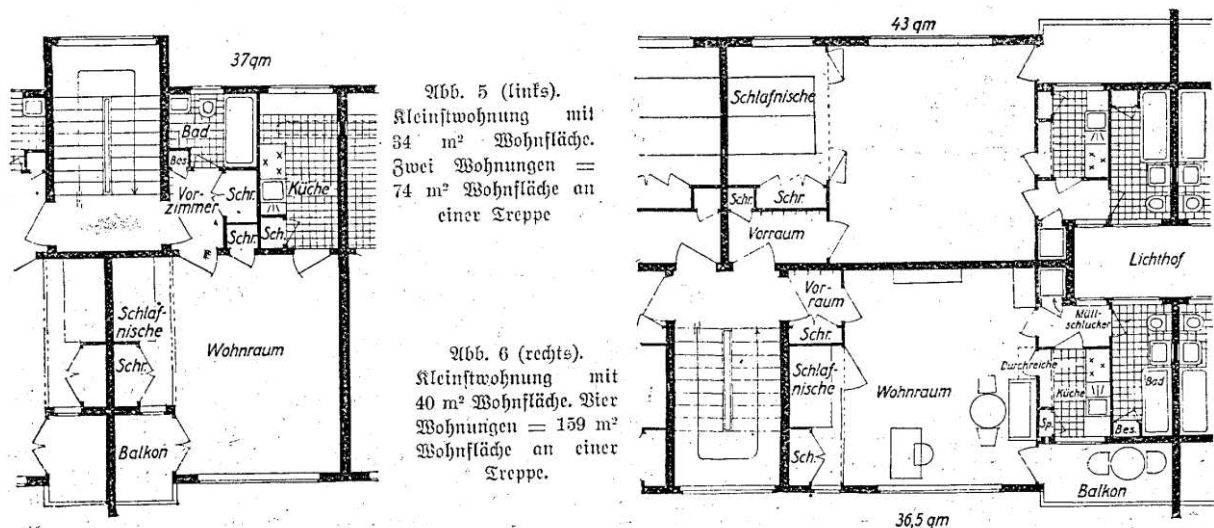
Wohnflächenvergleich Zwei-/Vierspänner, Grundrisse, um 1928.
